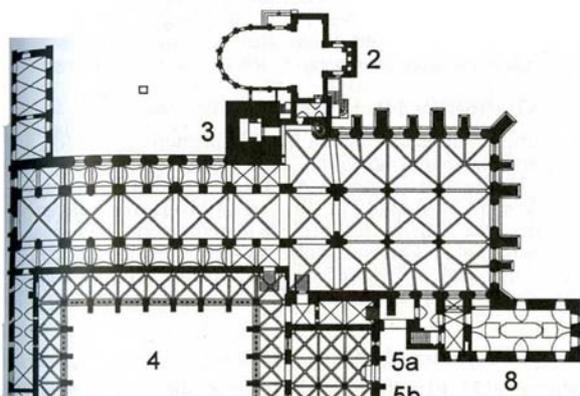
Stiftskirche Heiligenkreuz, Grundriss
